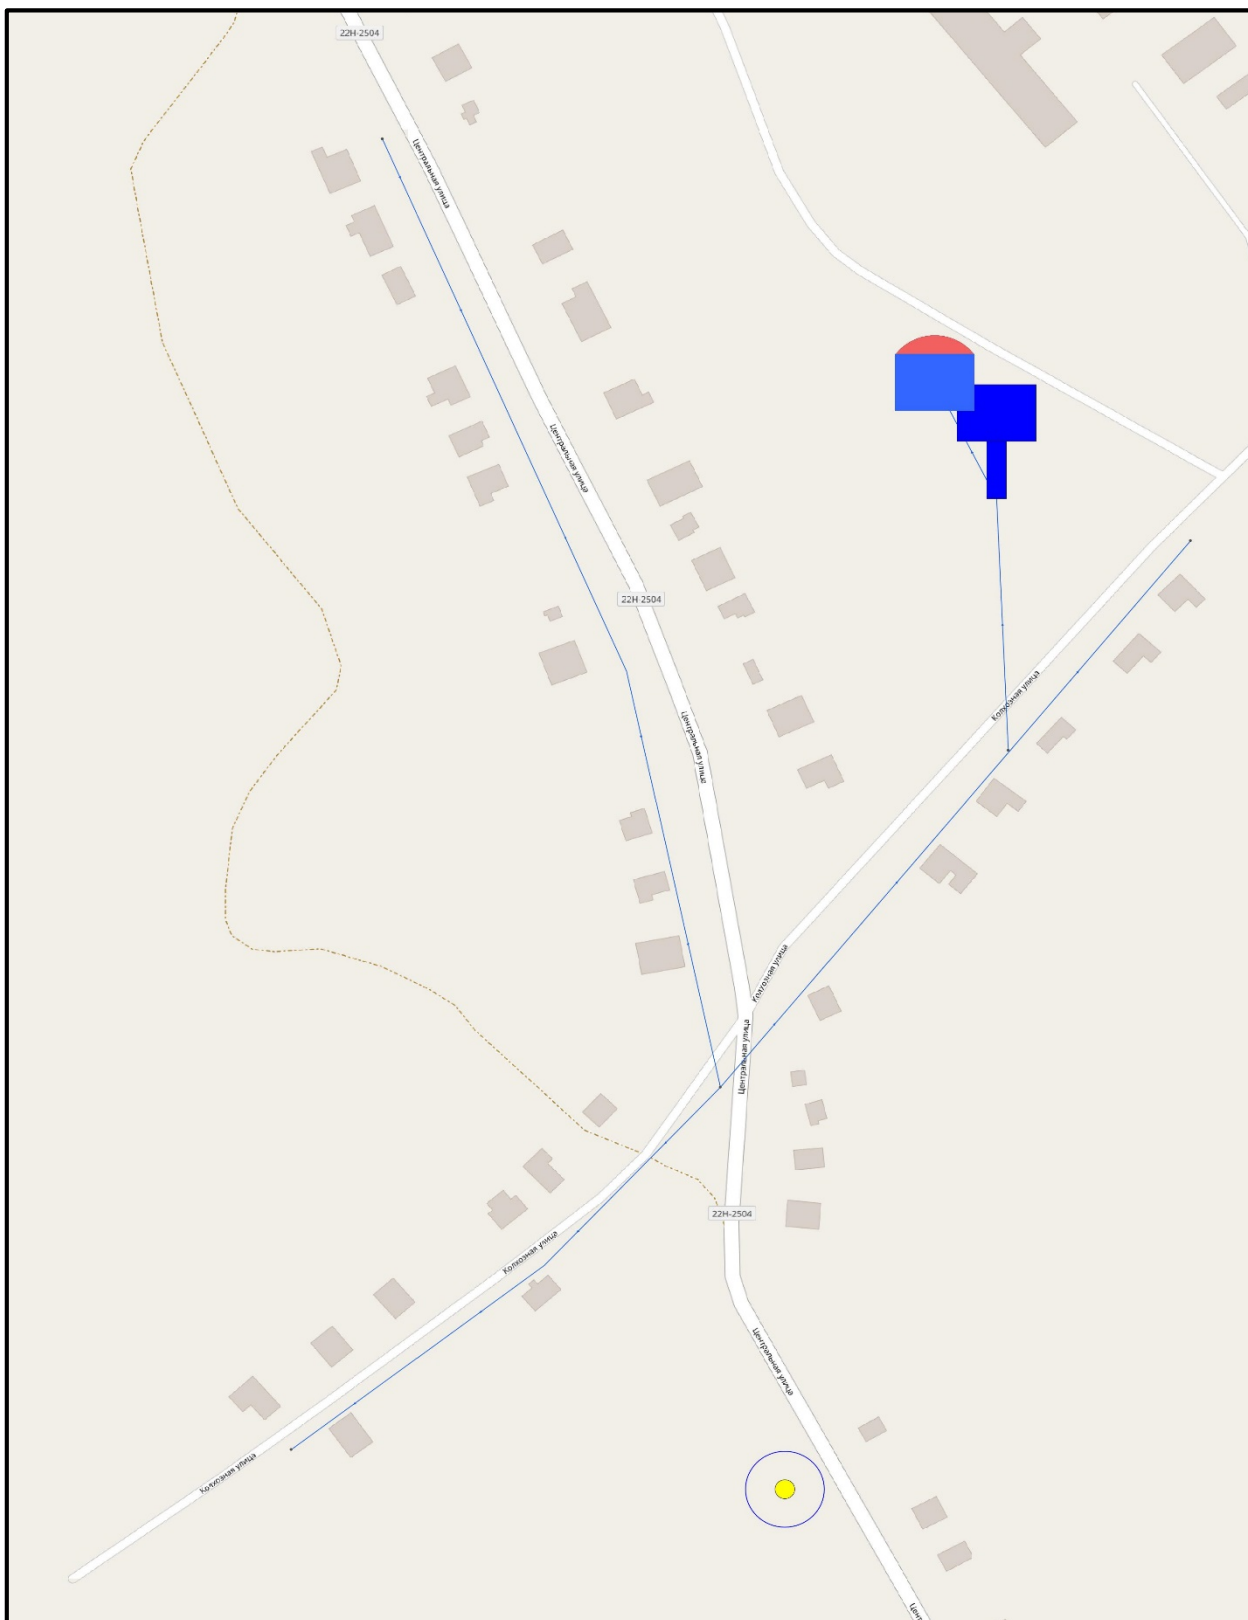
Схема водоснабжения д. Мангушево
